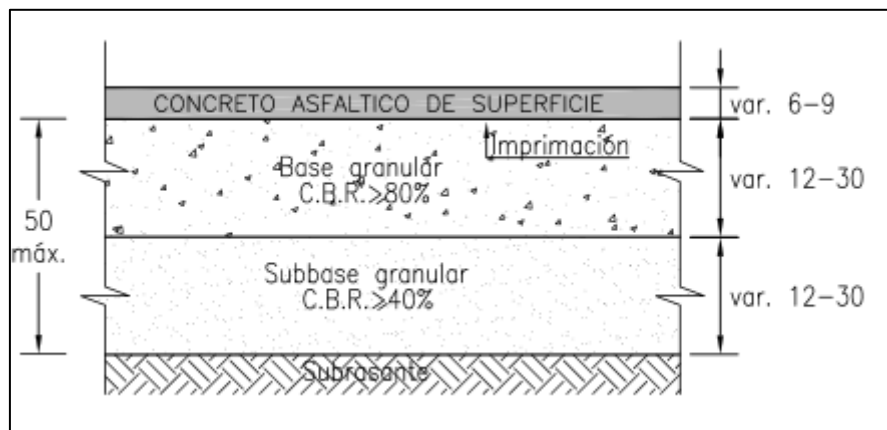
Sección tipo de pavimento para la zona de estudio. Las dimensiones están en centímetros. Tomado de Ministerio De Obras Publicas (2018).
